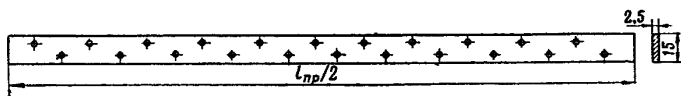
Шаблон для разметки отверстий для нагелей и стяжных болтов
